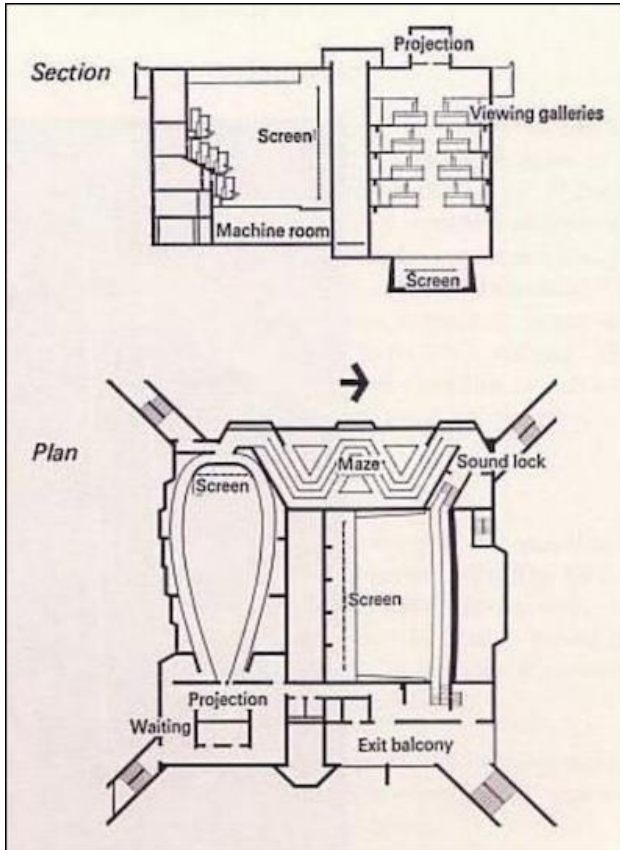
Dibujo de la planta del Labyrinth Pavillion (1967)
